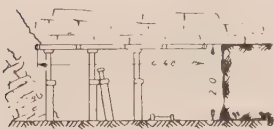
Ausbauschema beim Strebbbruchbau mit Schüttelrutsche
